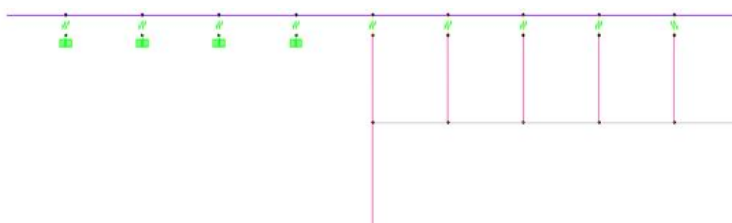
Viaducto de Porto. Modelo en SAP 2000. Detalle en estribo 1
